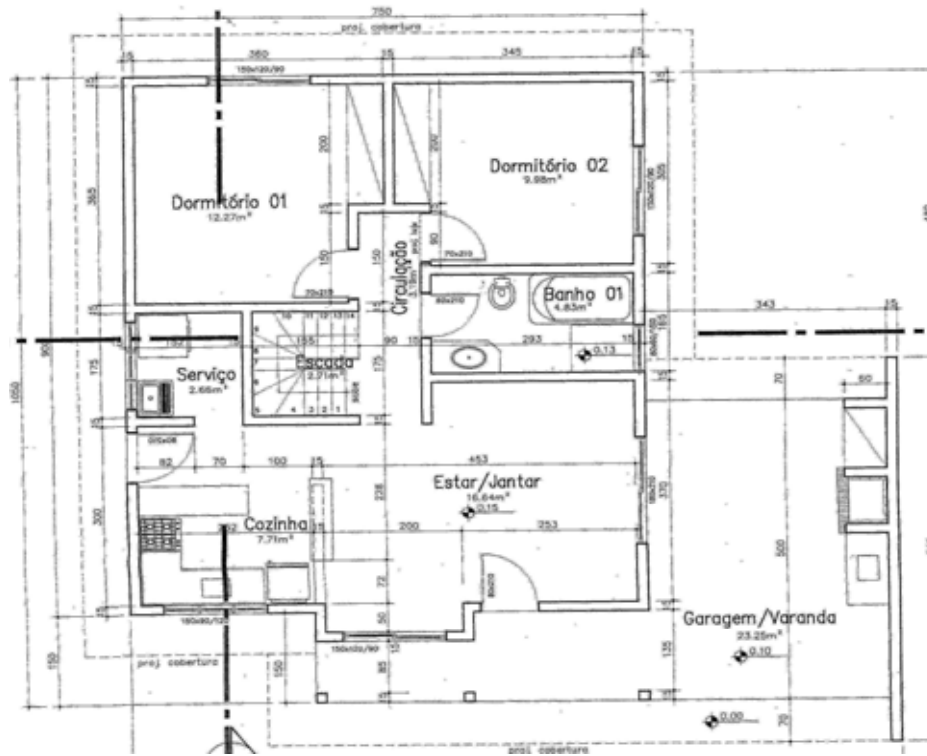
Projeto Estudo de Caso 2 - Planta Baixa Pavimento Térreo
